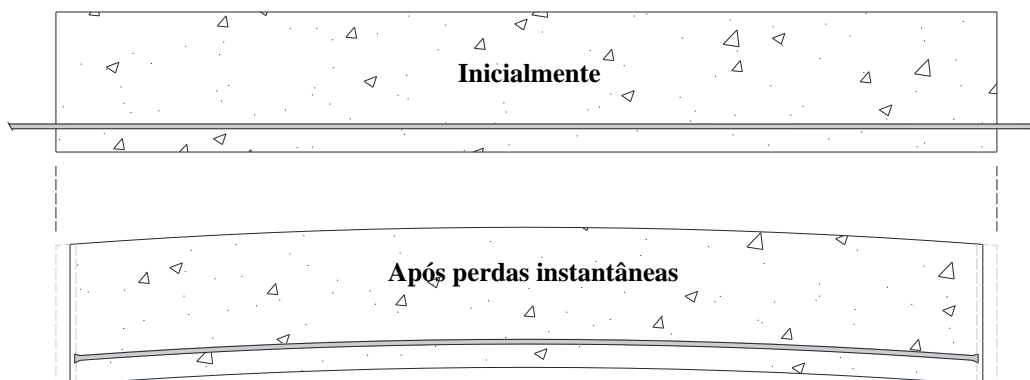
Aspecto após deformação instantânea do betão e reentrada das armaduras
